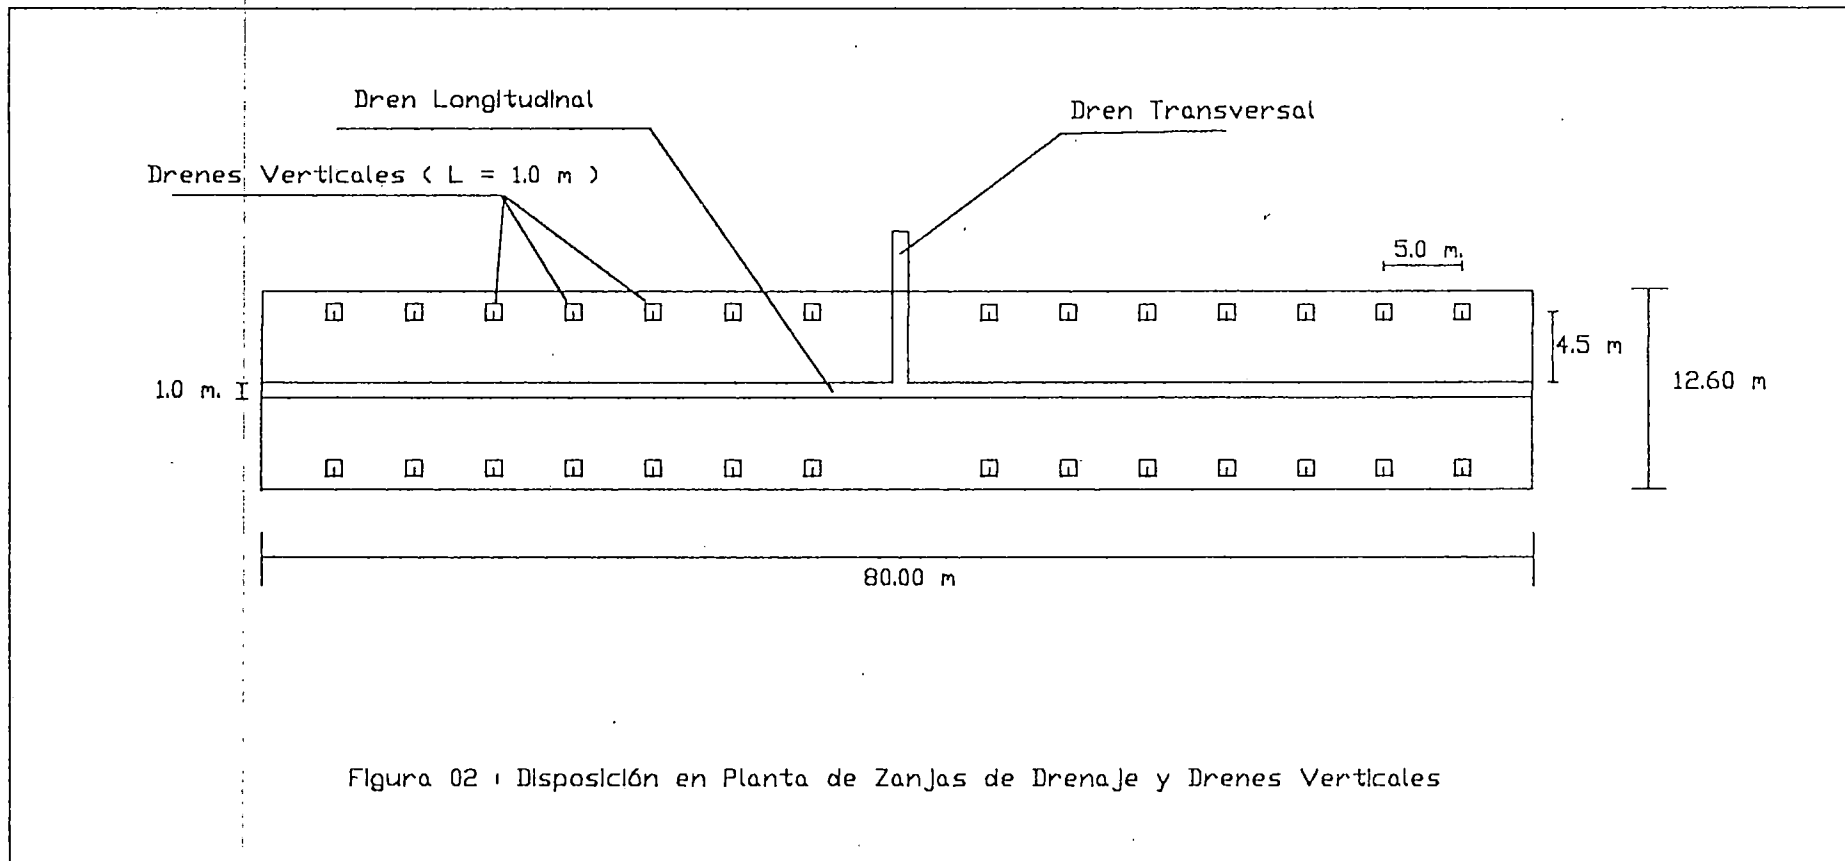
Disposición en Planta de Zanjas de Drenaje y Drenes Verticales
